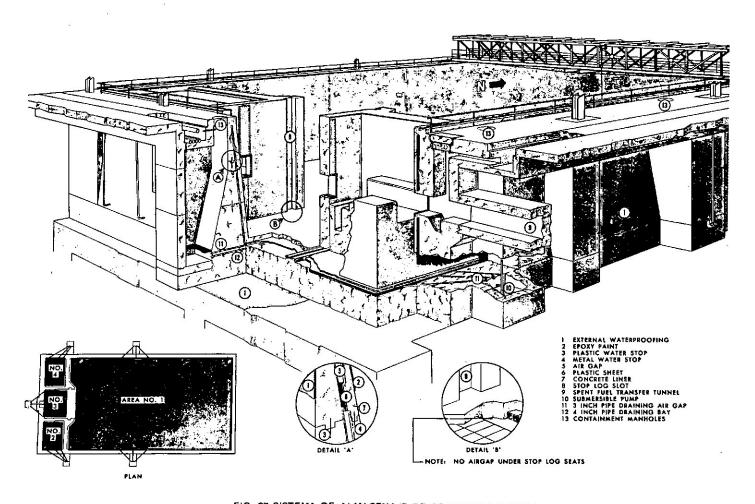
SISTEMA DE ALMACENAJE DE COMBUSTIBLE QUEMADO
